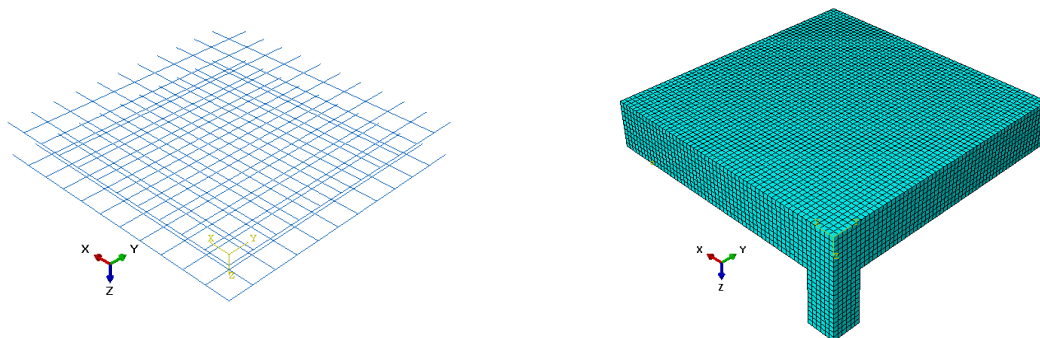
obere und untere Bewehrungslage aus Fachwerkelementen (links) und Vernetzung des Betonkörpers mit Volumenelementen (rechts)
